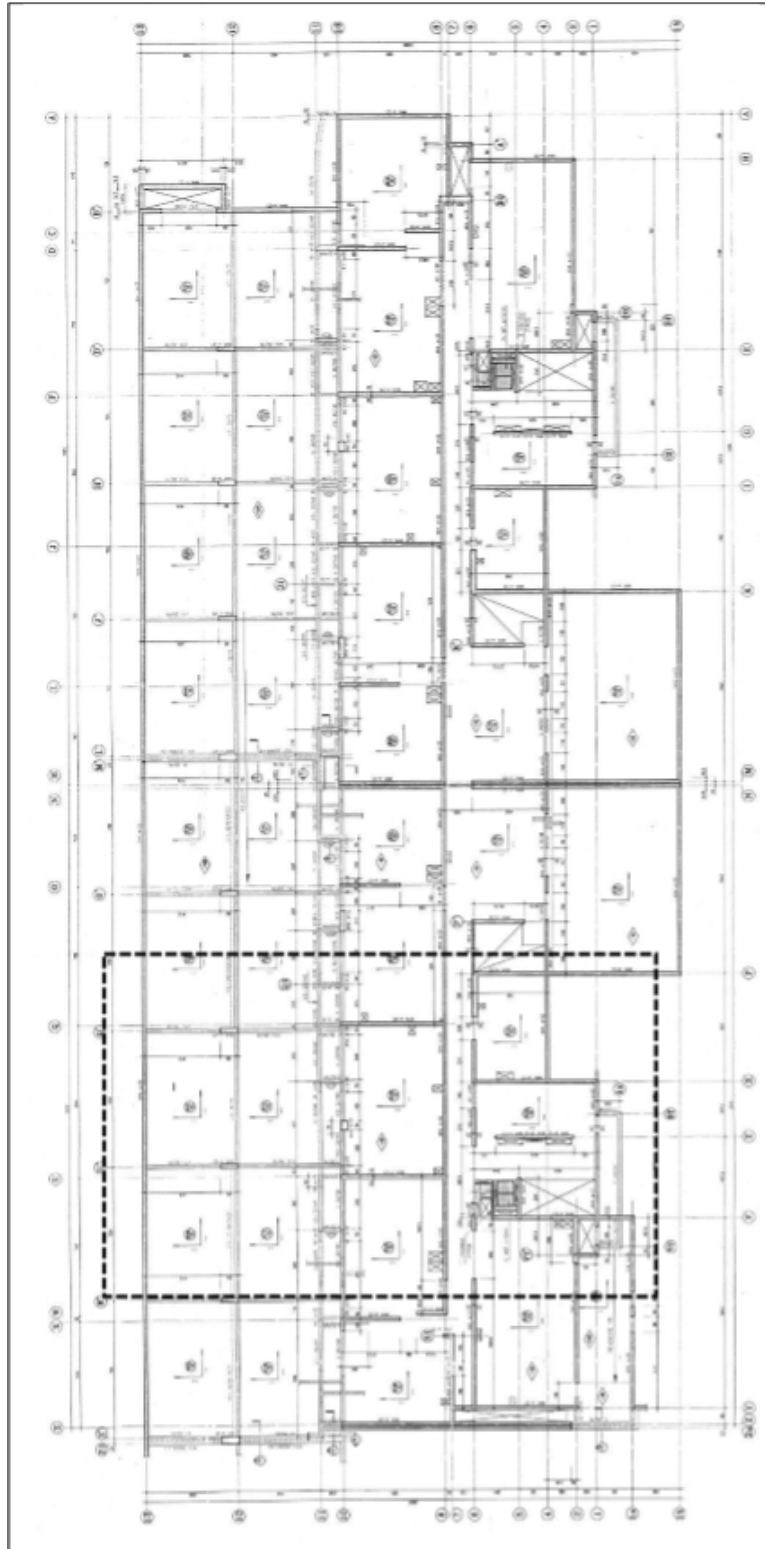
Vista general de planta del edificio Sol Oriente [7].
